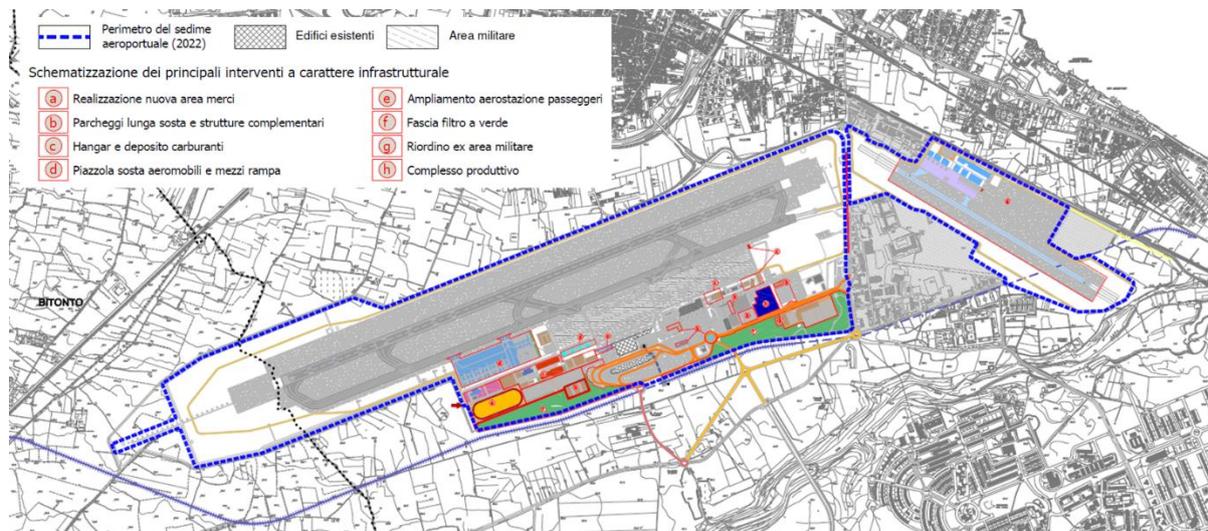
Rappresentazione interventi previsti dal Master Plan 2022 per l'aeroporto di Bari (stralcio elaborato TAV.01 "Interventi previsti dal Masterplan 2022")
